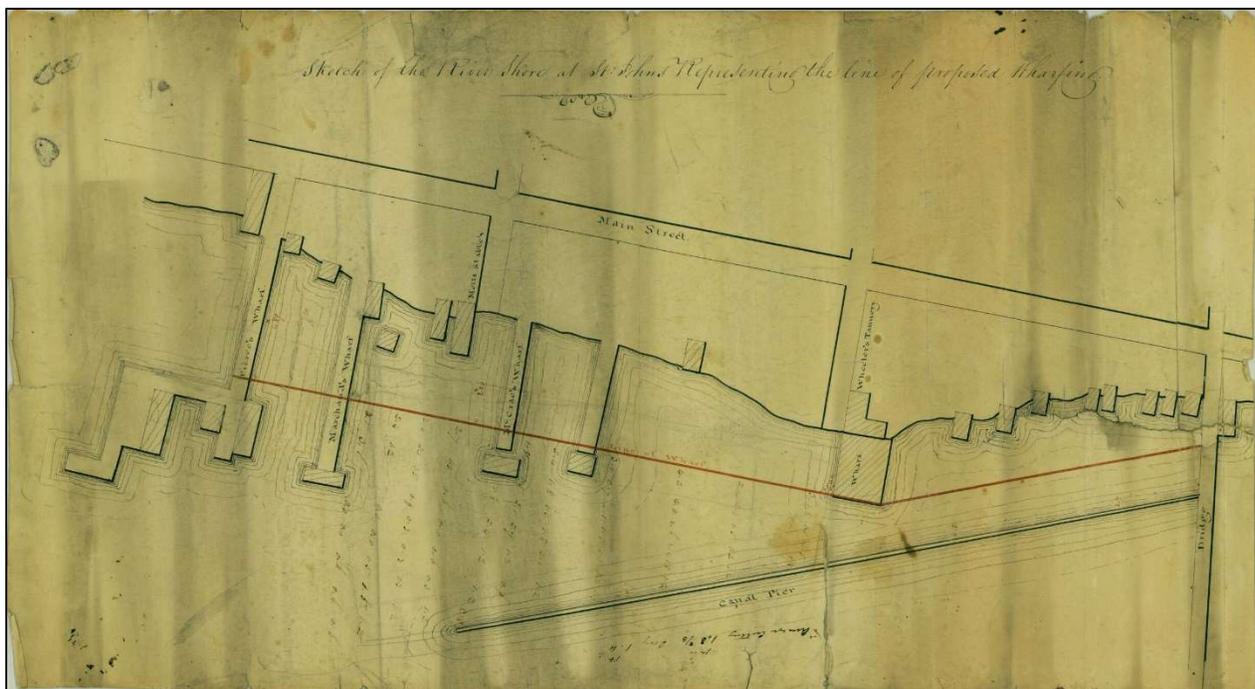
Plan du projet de quai de 1842 sur la rive du Richelieu au sud du pont Jones (source : BAnQ-VM, P318/S8/P79).
